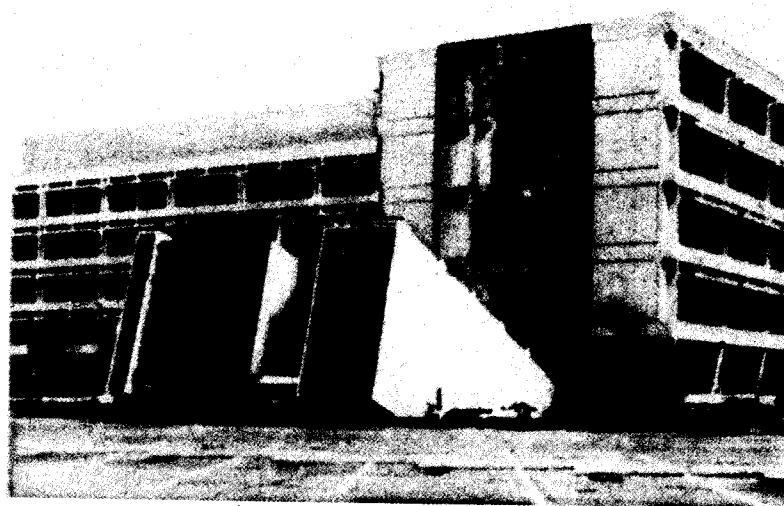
Башня с лестничными клетками, упавшая наружу, здание больницы Олив Вью
